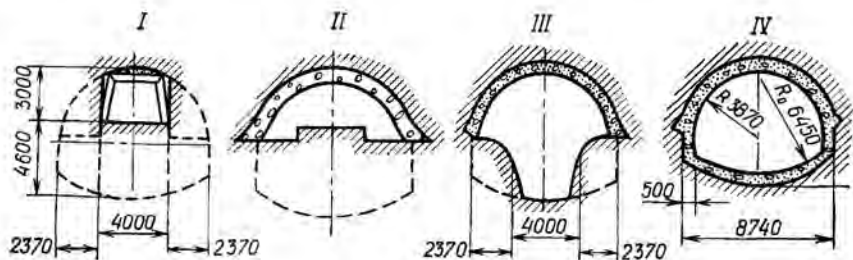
Схема проходки сопряжений с передовой выработкой в своде
